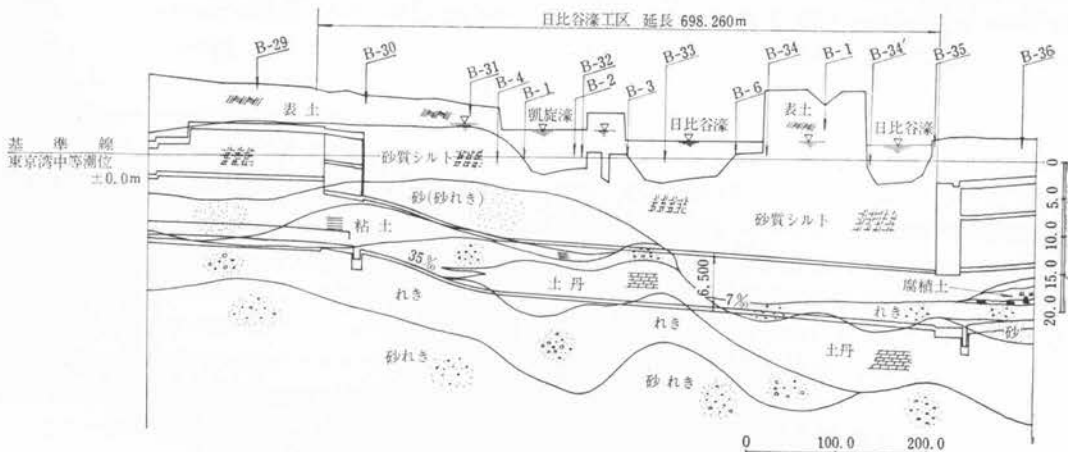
営団地下鉄8号線日比谷駅区地質縦断面図
